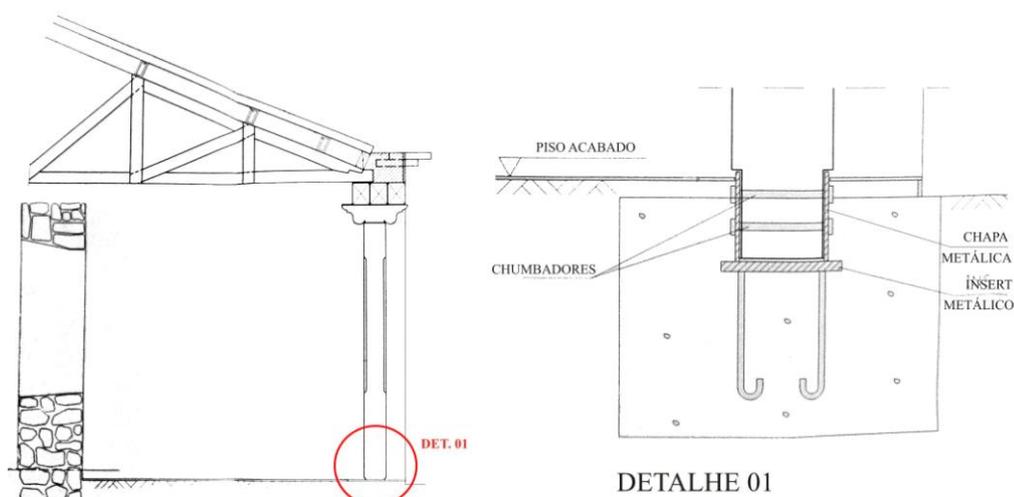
Fotos digitais do corte transversal da varanda e detalhe da base do pilar de madeira.
